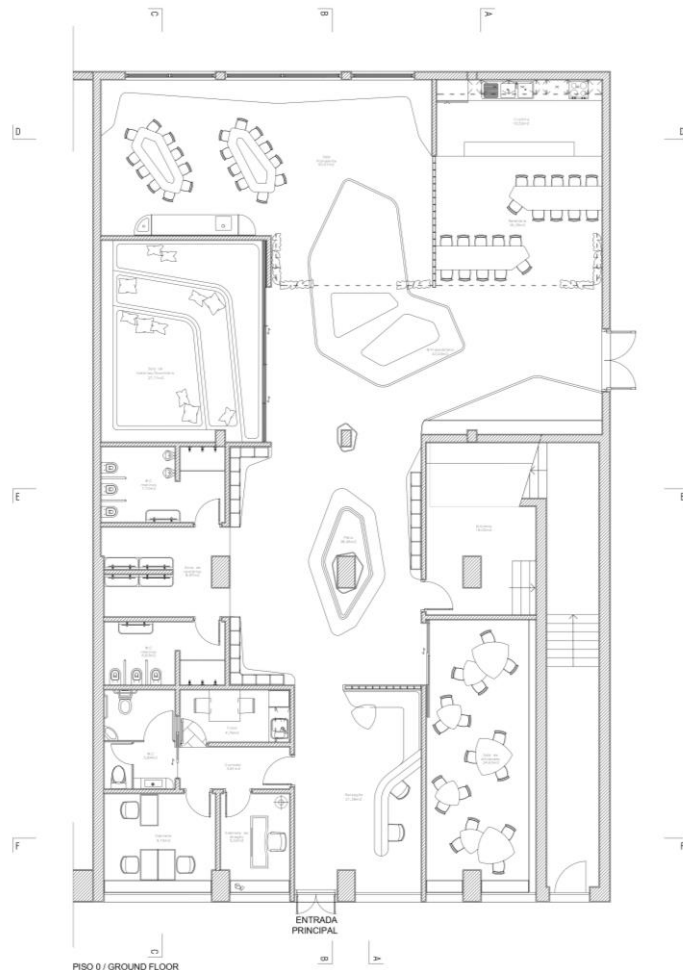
Planta da proposta final. Fonte: Augusta Ngonga, 2024.
